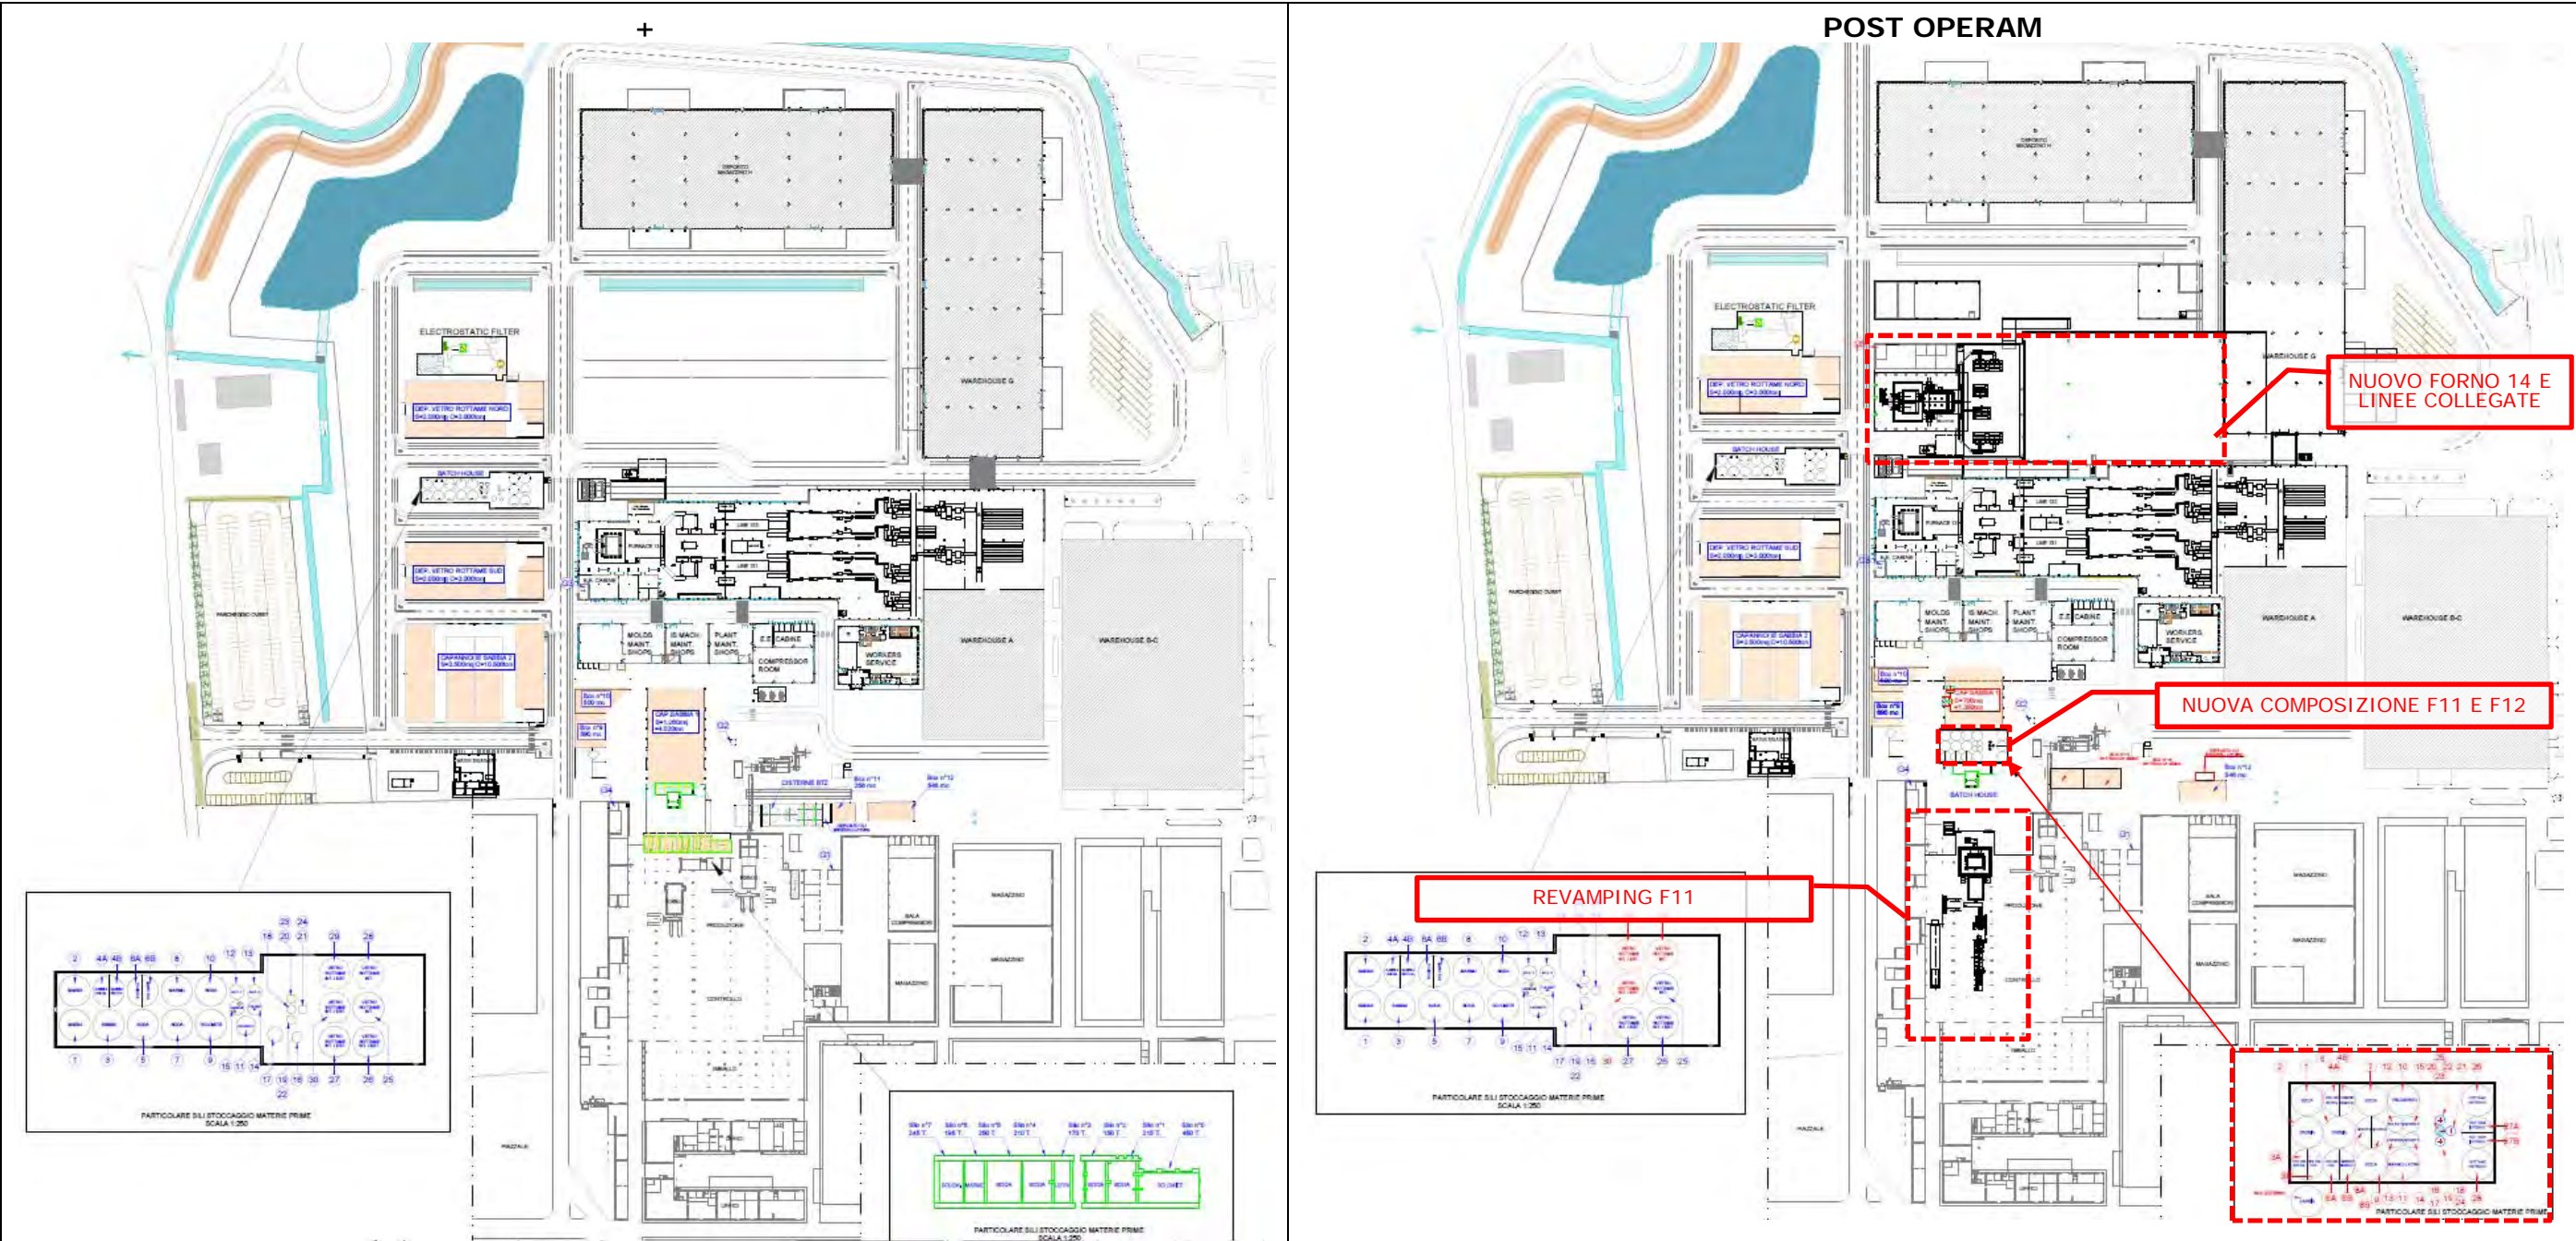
Planimetria dello stabilimento: configurazioni autorizzata e di progetto
